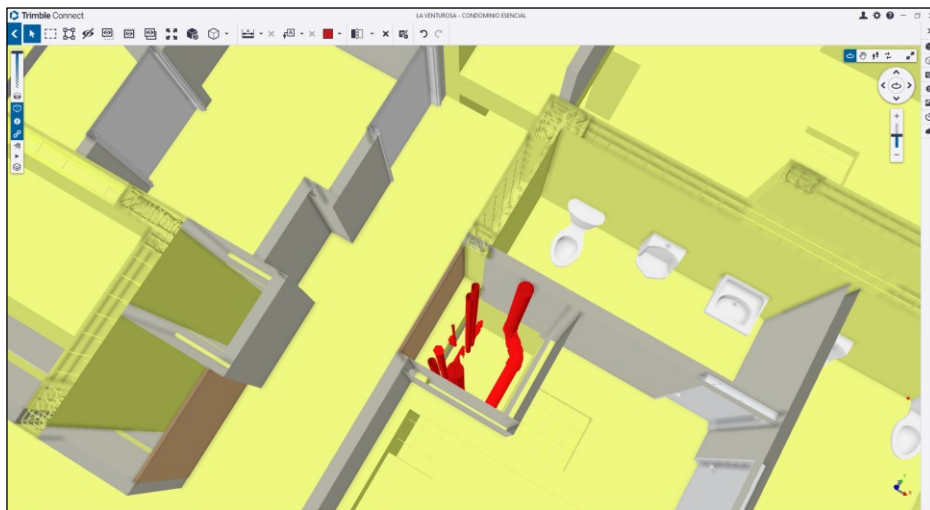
Compatibilización entre Arquitectura, Estructuras, Instalaciones sanitarias en la plataforma colaborativa Trimble Connect Fuente: Elaboración propia
